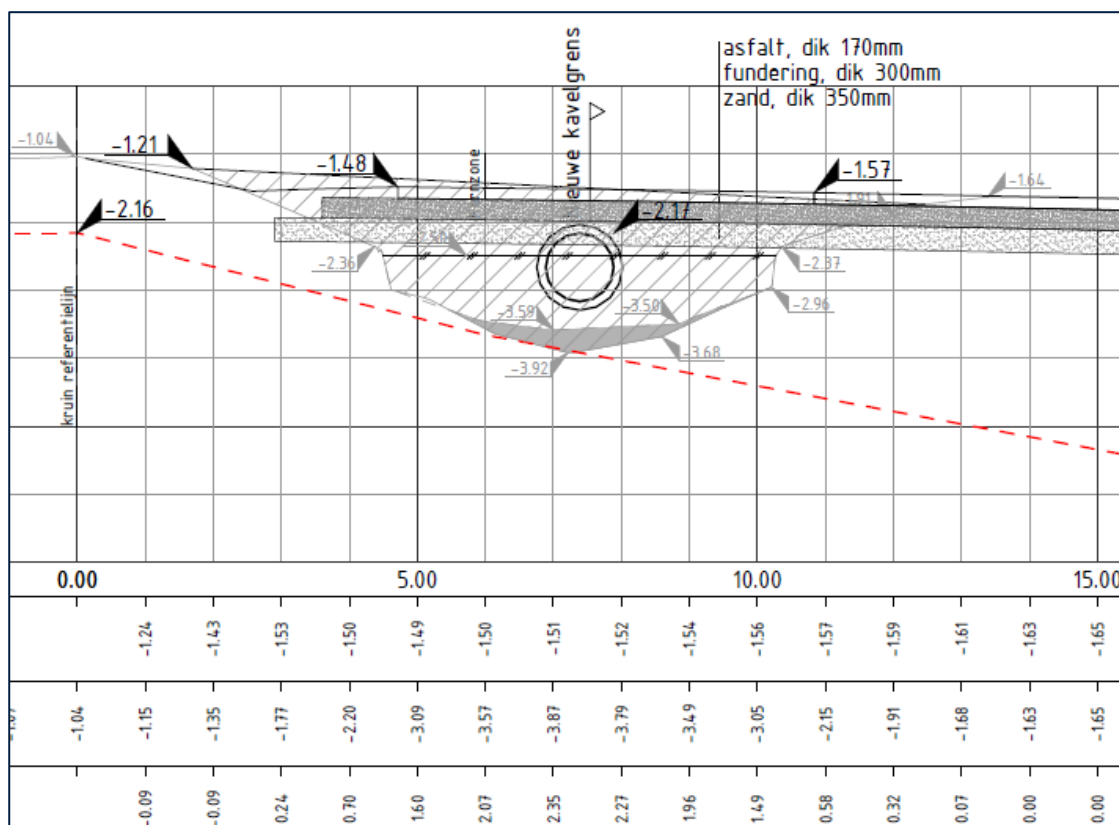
Uitsnede DWP5 met overzicht te ontgraven en te dempen watergang zuidwest zijde projectgebied. Fugro, tek.nr. 2021-188660_03, blad 2, d.d. 27-5-2021.
